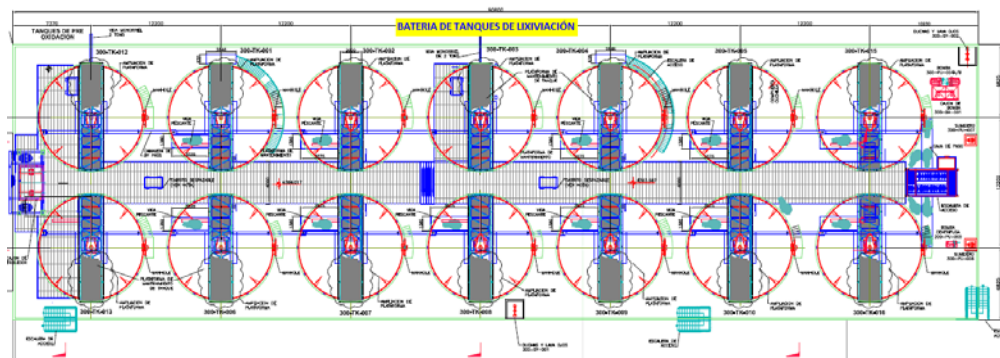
Batería de 14 Tks de Lixiviación (Fuente: Empresa consultora ABC)
